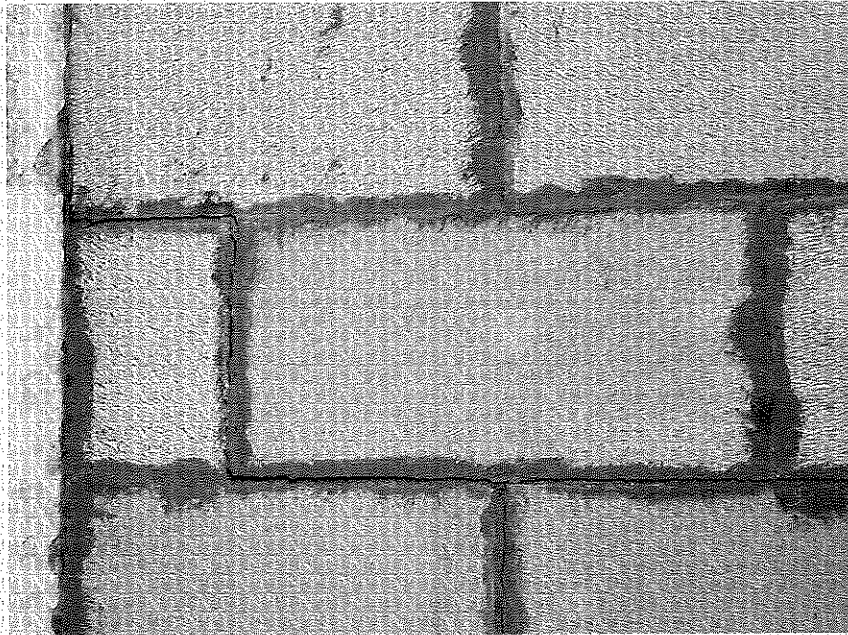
Minuto 17, aparición de fisura longitudinal a mitad de altura
